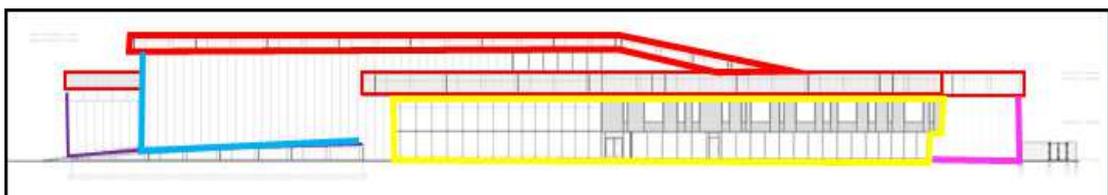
façade principale du centre MINTO source : www.archdaily.com traité par l'auteur
